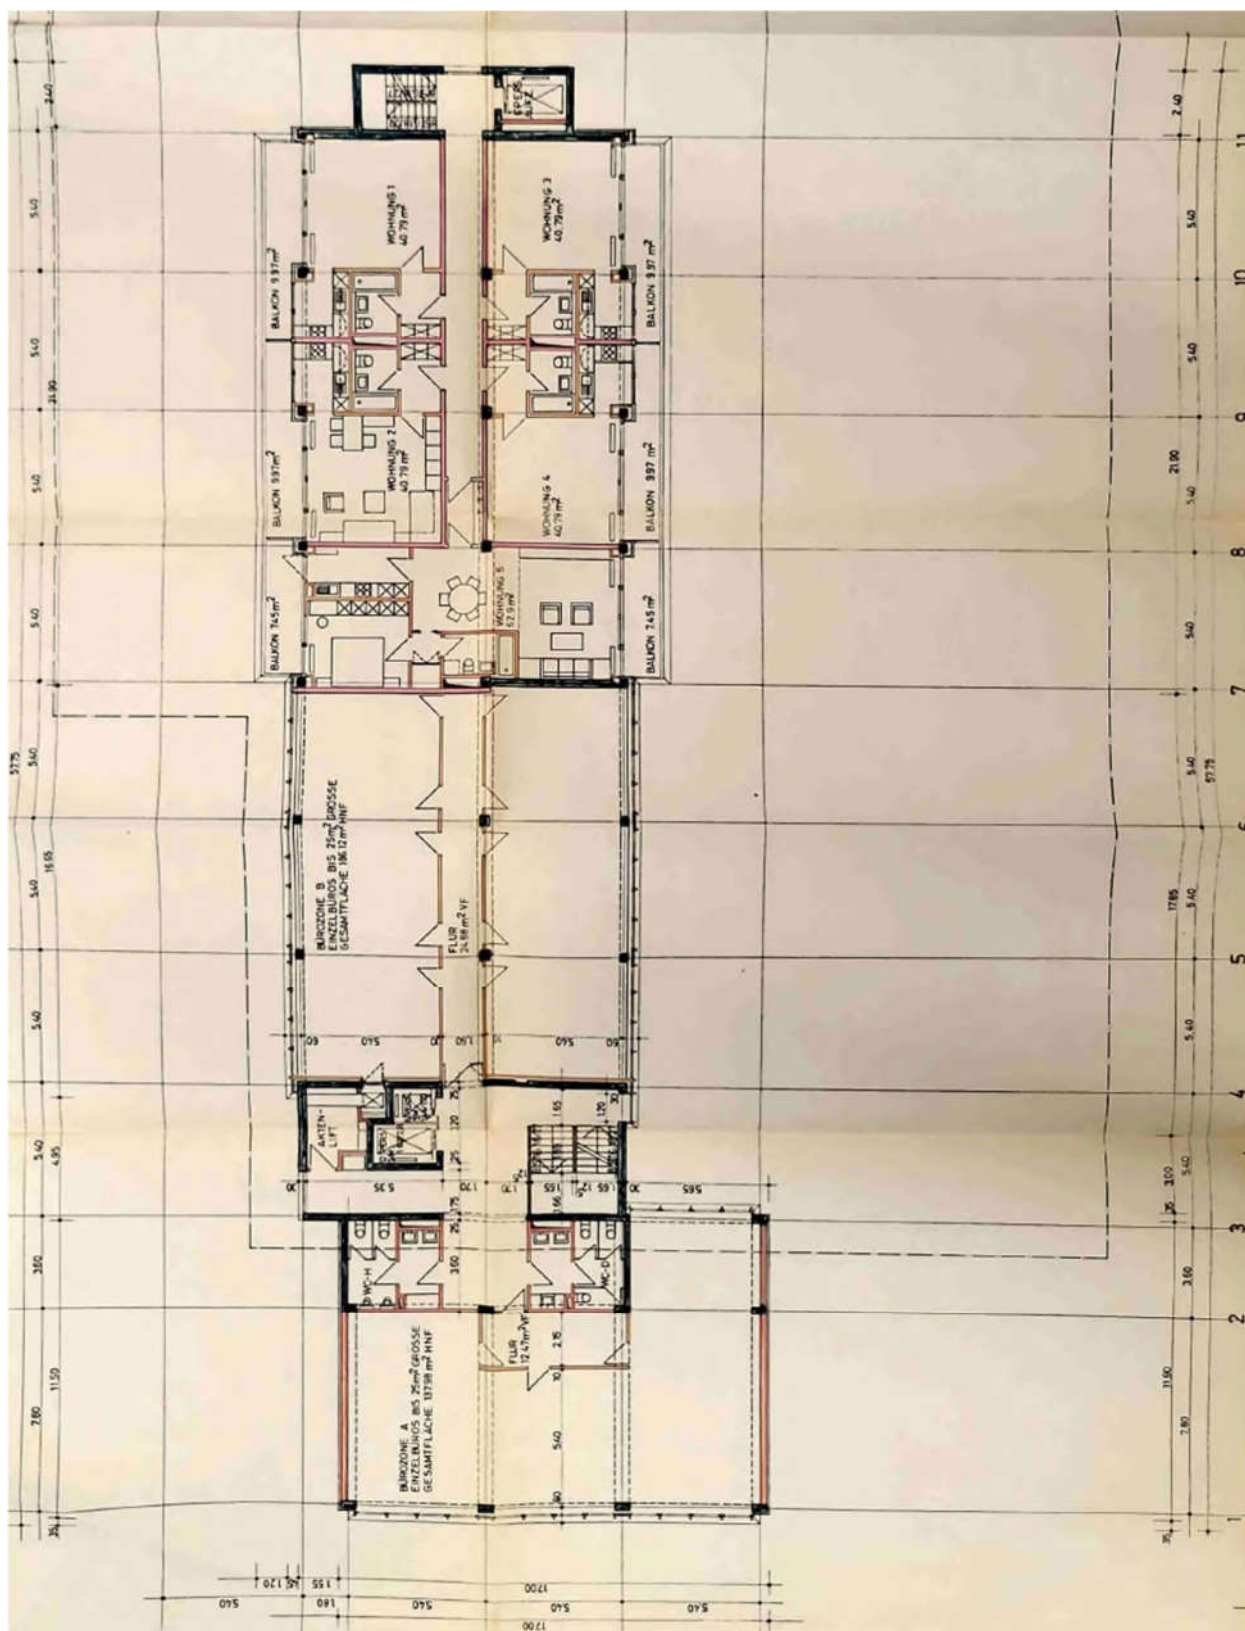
Grundriss 3. Obergeschoss
